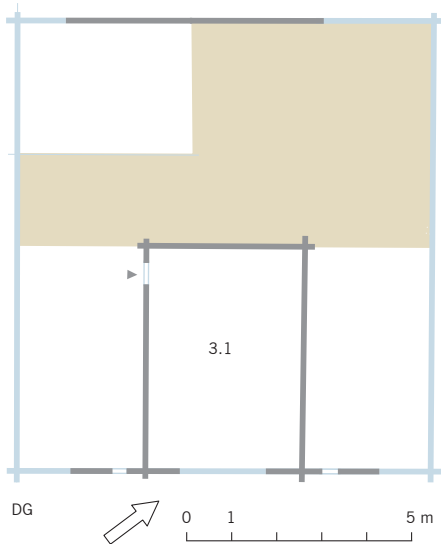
Haus Unterblacki in Unterägeri, Grundriss des Dachgeschosses.
